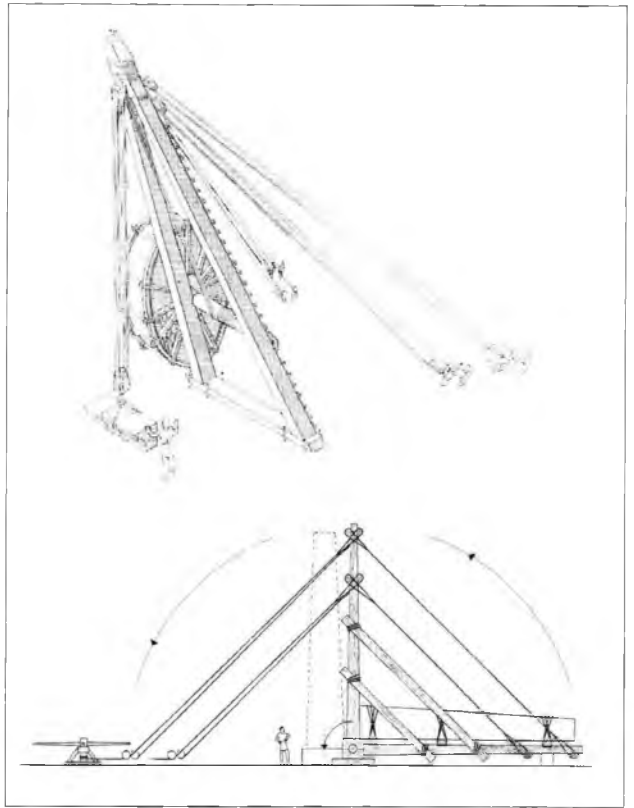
Reconstrucción de máquinas elevadoras (de J. P. Adam).
